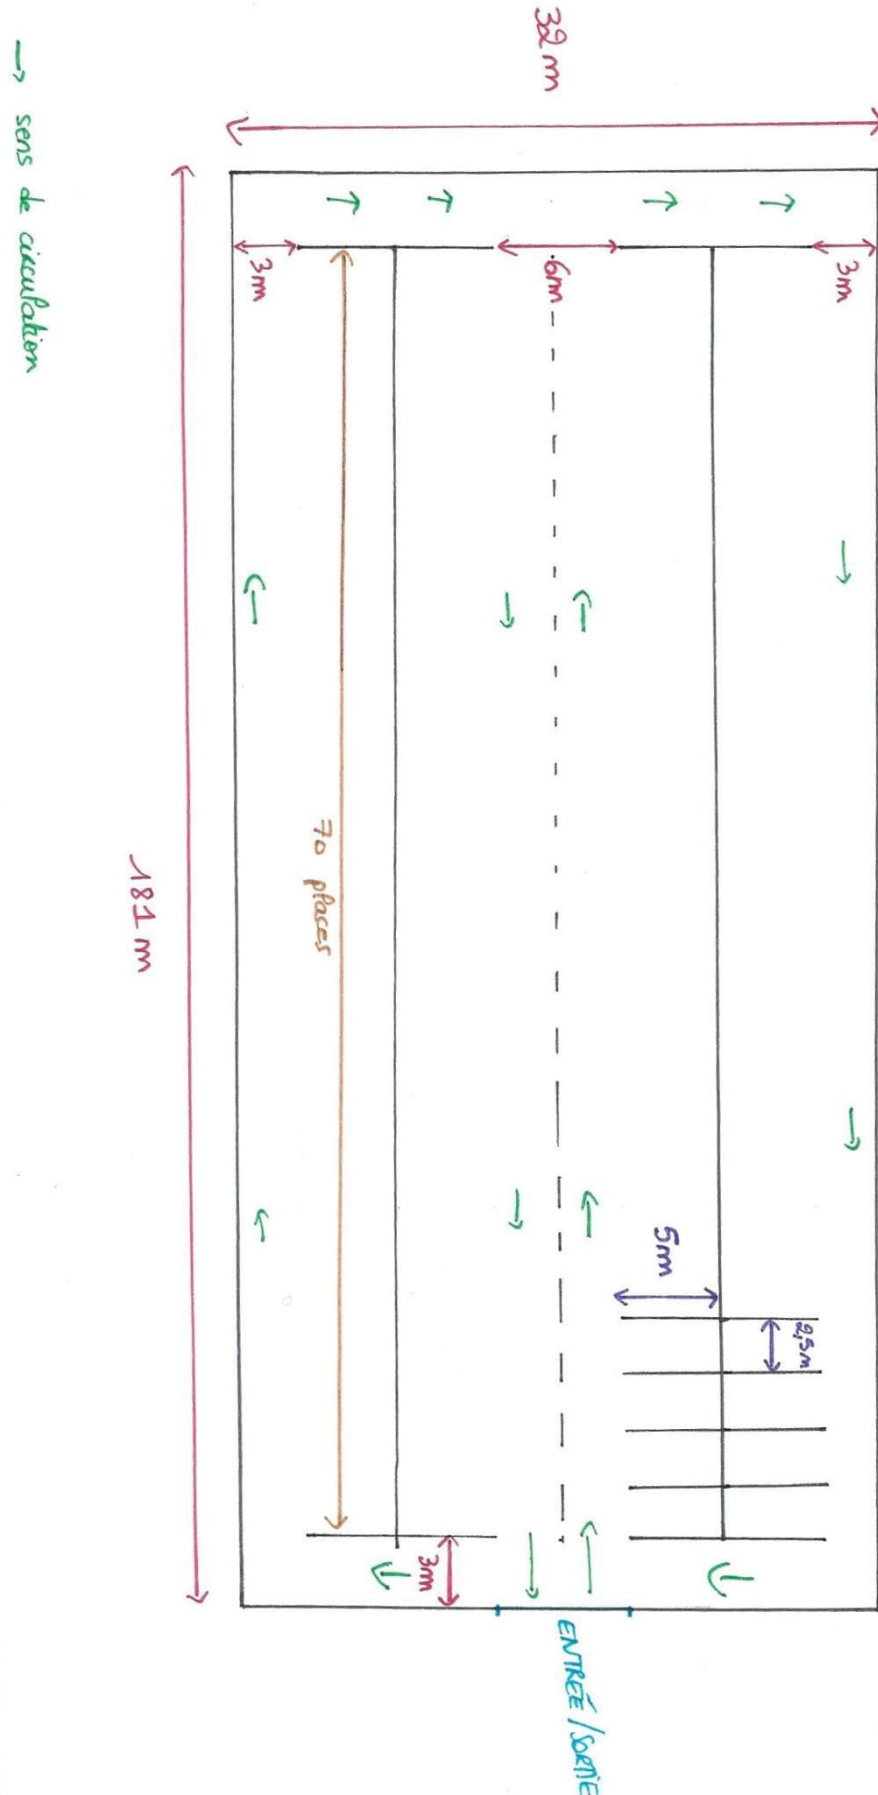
PLAN DU PARKING - REALISATION : HINDEE GOURY
